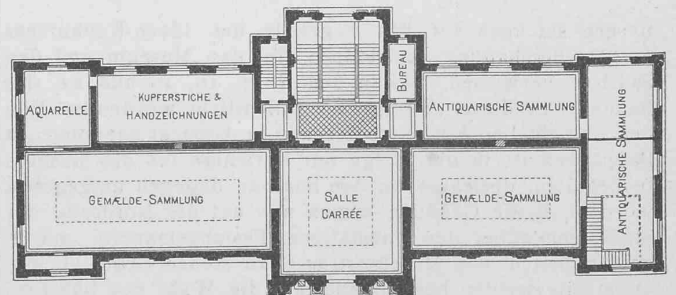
Grundriss vom Obergeschoss. — Masstab 1:600.
